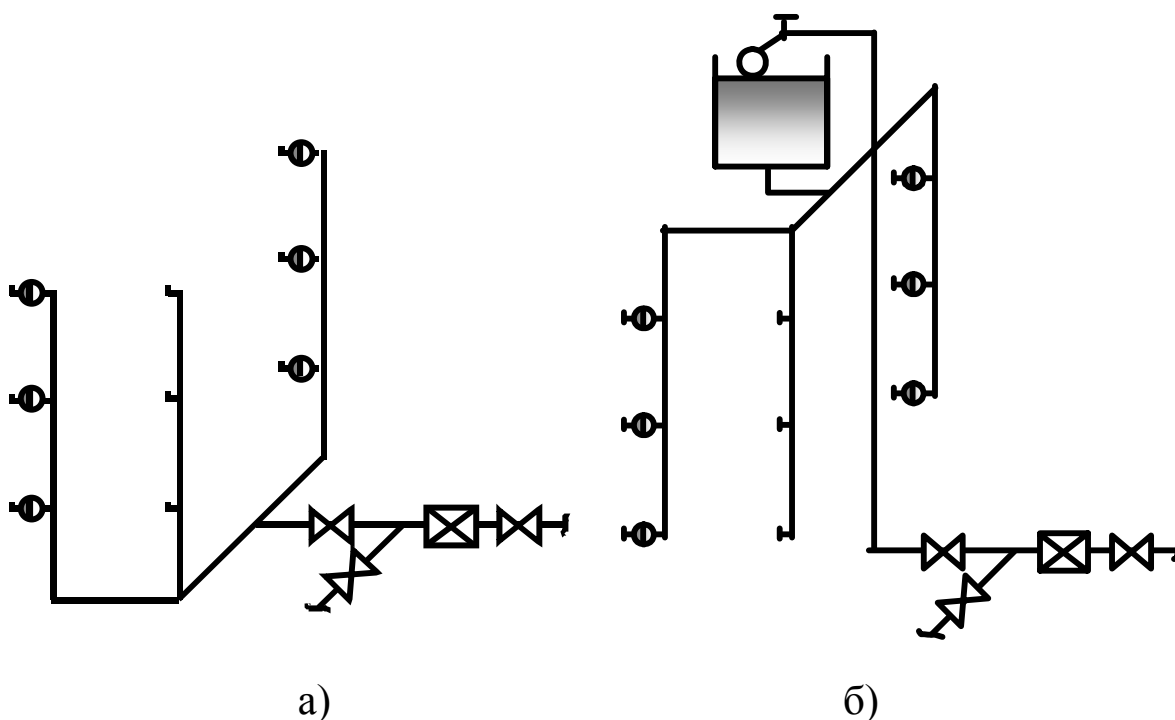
Схеми внутрішнього протипожежного водопроводу:
